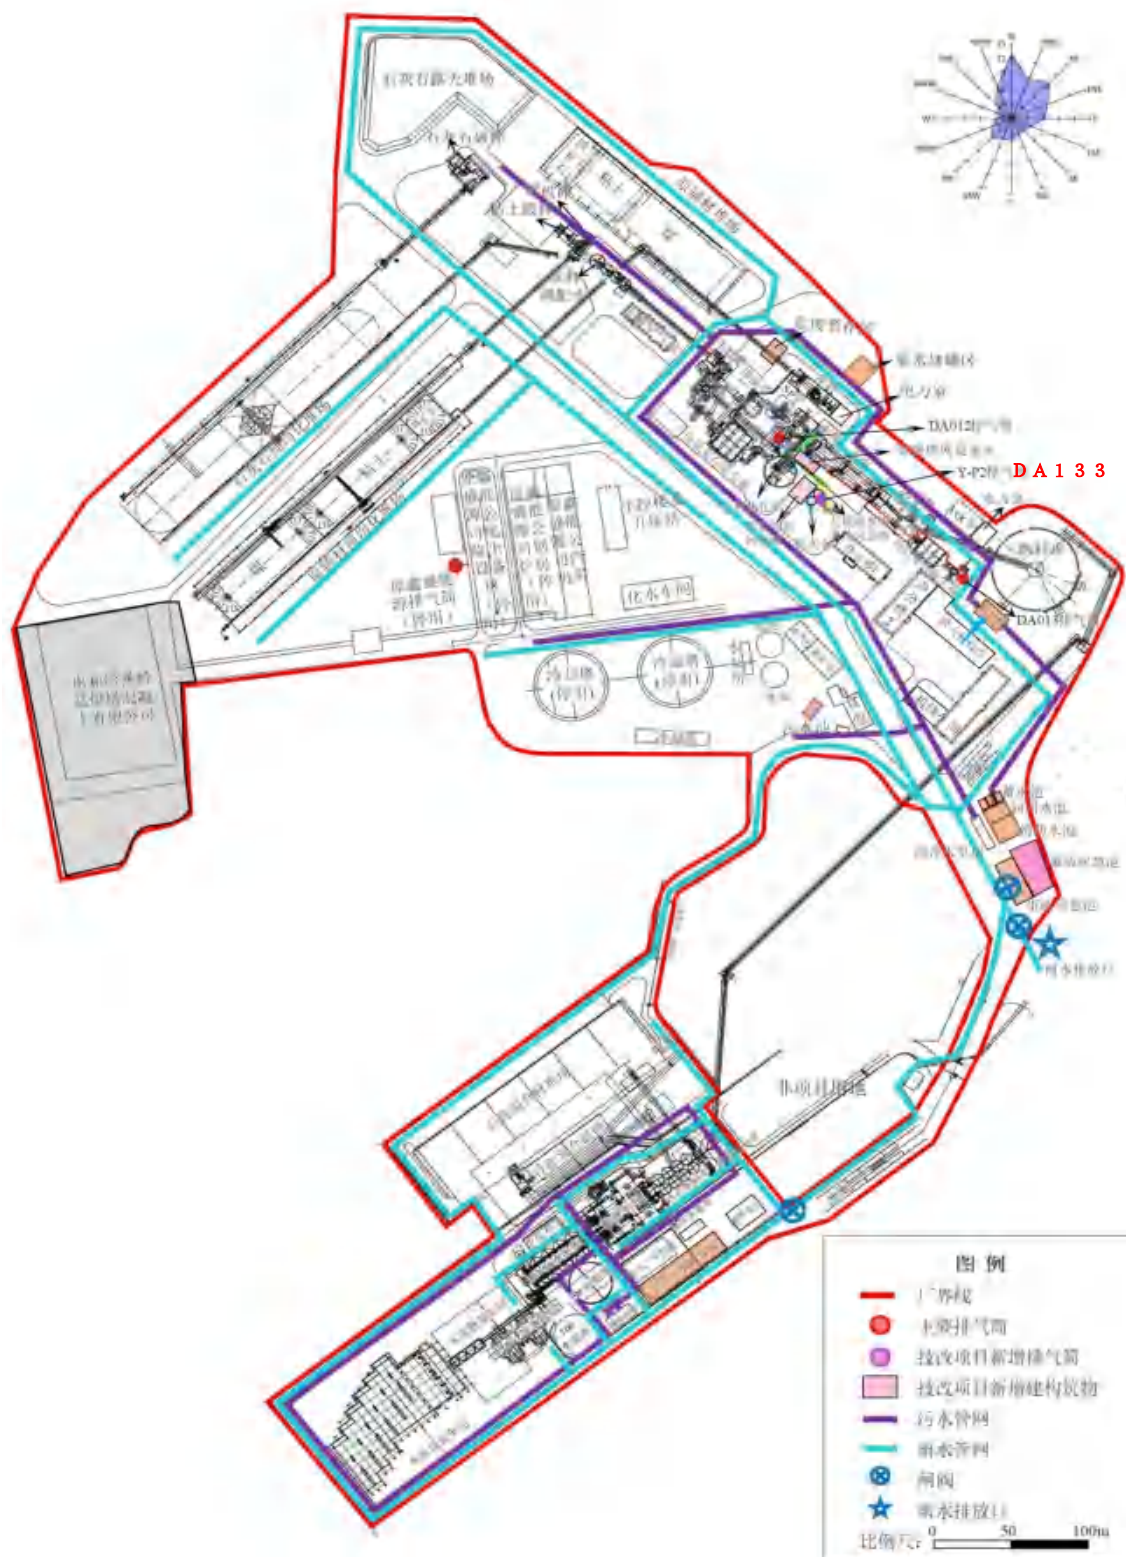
水泥窑协同处置铝灰项目全厂总平面布置图
